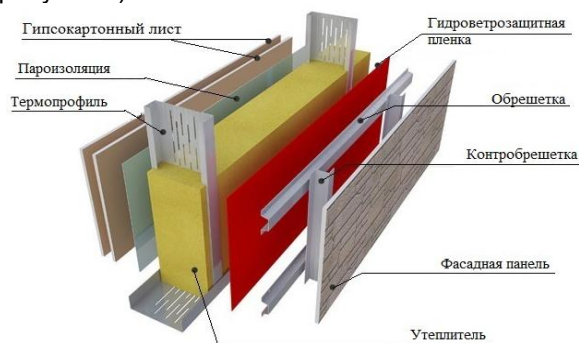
Конструкция термопанели с навесным вентилируемым фасадом
